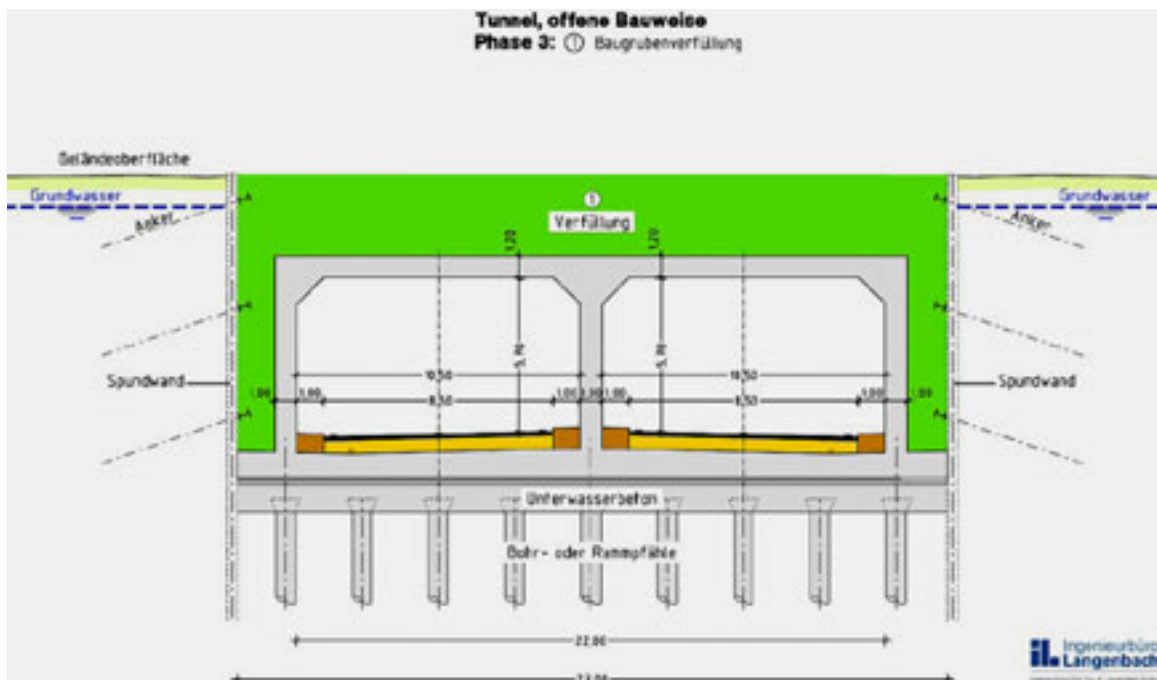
Tunnel in offener Bauweise (Bauphase 3)
